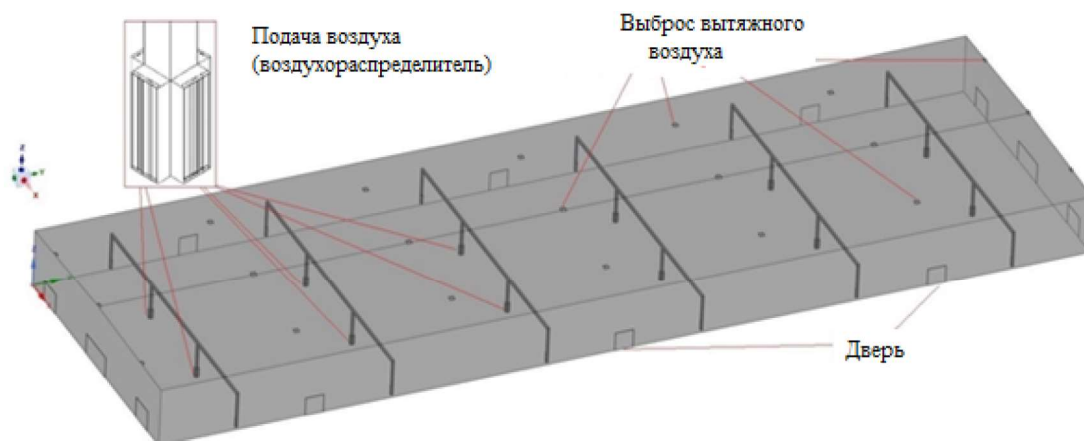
Системы подачи и удаления воздуха сварочного цеха
